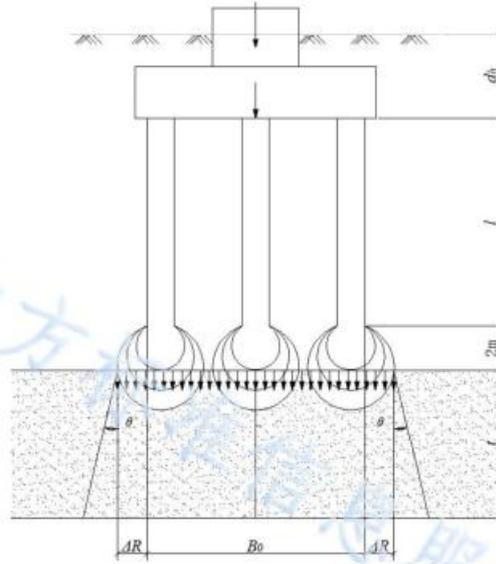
软弱下卧层计算示意 (l—直杆段混凝土桩身长度)
